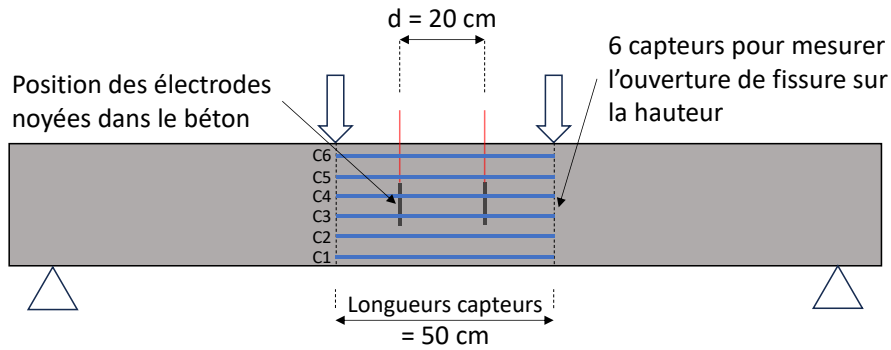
Position des capteurs fictifs de déplacement pour déterminer la hauteur de fissuration sur la partie centrale des poutres (par DIC)
